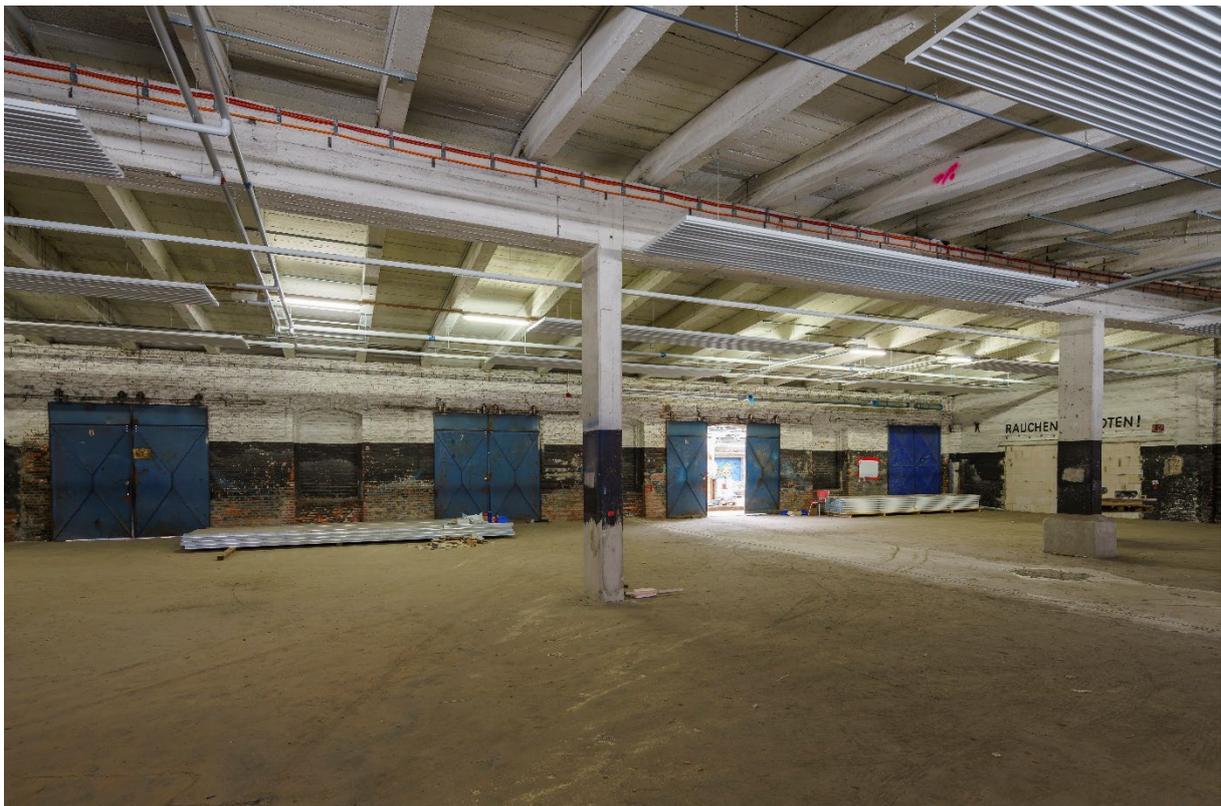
Exemplarischer Einblick in eine Hallenfläche der Halle 2 (Mieteinheit 2C) während der Sanierungsmaßnahme vor dem Einbau neuer Türen und Fenster. © Miguel Ferraz
